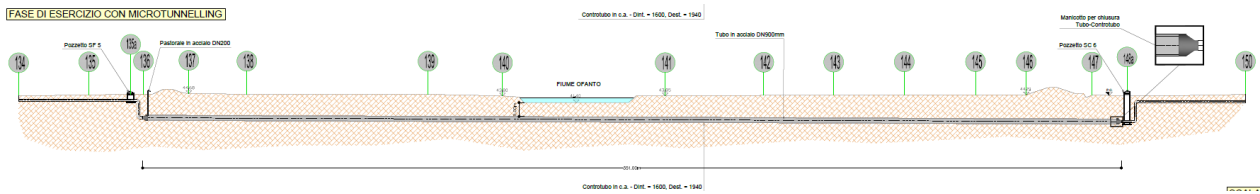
Sezione attraversamento mediante microtunneling Fiume Ofanto
